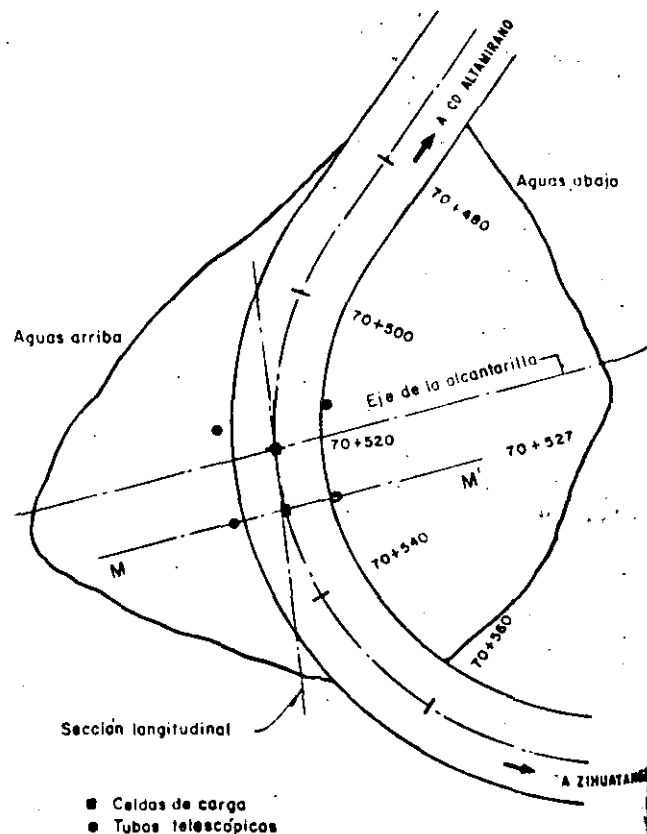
Planta de localización de la instrumentación dispuesta en el pedraplén "La Chachalaca".
